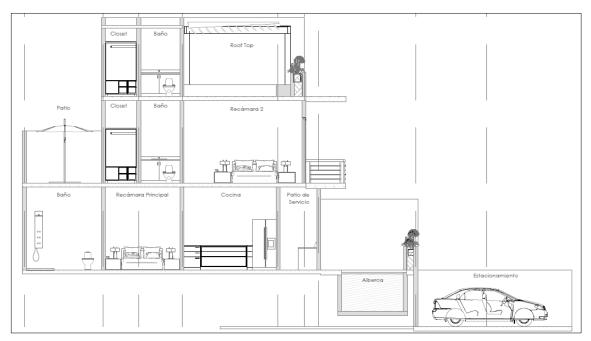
Corte transversal de espacios que tendrán las Villas Tipo 2 (Villa 4, 5 y 6).
